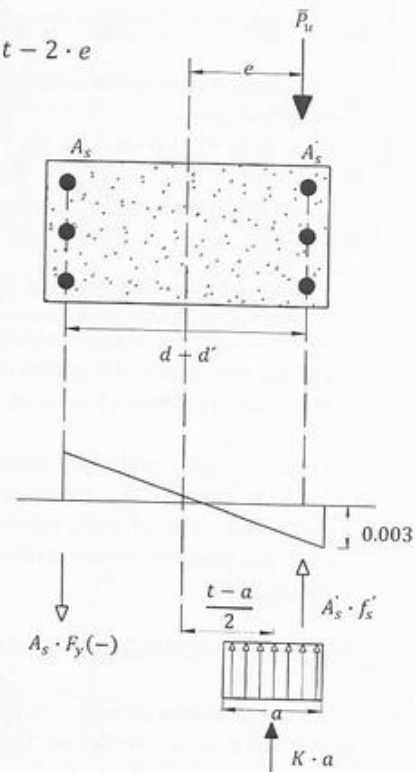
Columna rectangular con acero de refuerzo en los bordes
